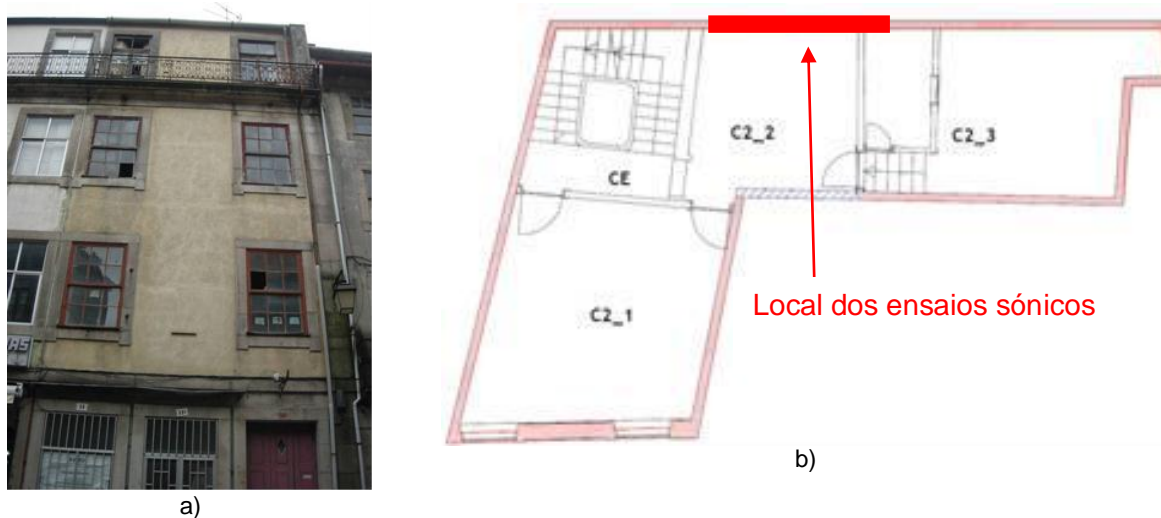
Edifício do Largo dos Lóios: a) vista da fachada principal; b) planta esquemática do rés-do-chão.
